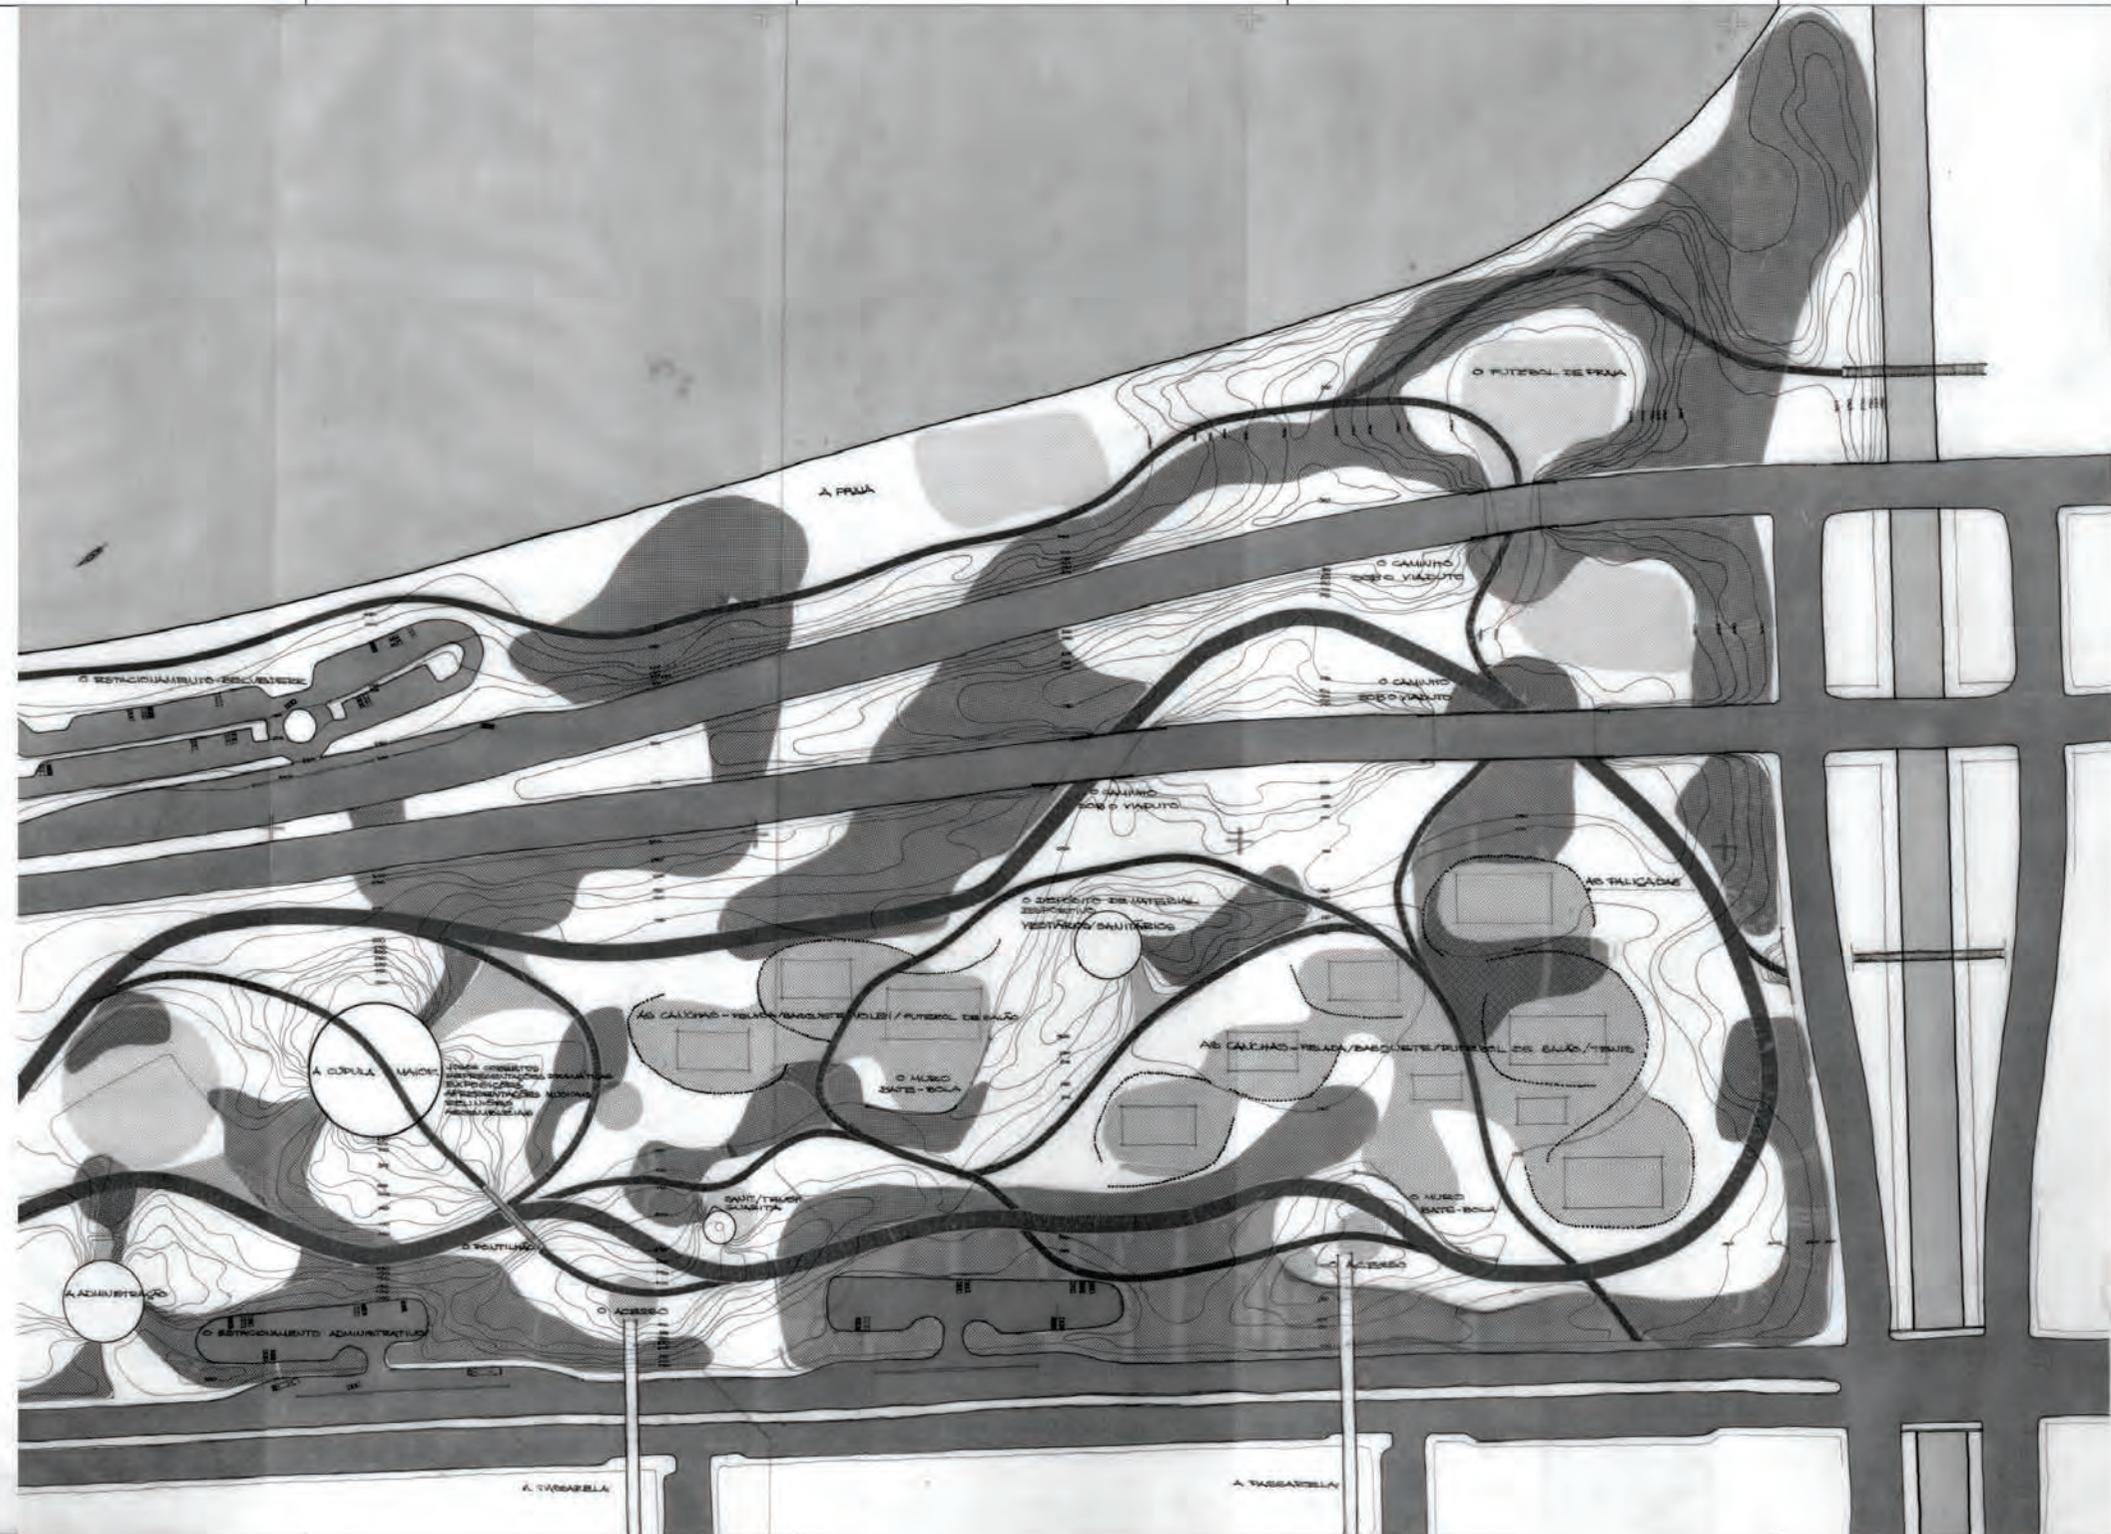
prancha original do concurso – Prancha 10 Estrutura | planta (setor esporte).
